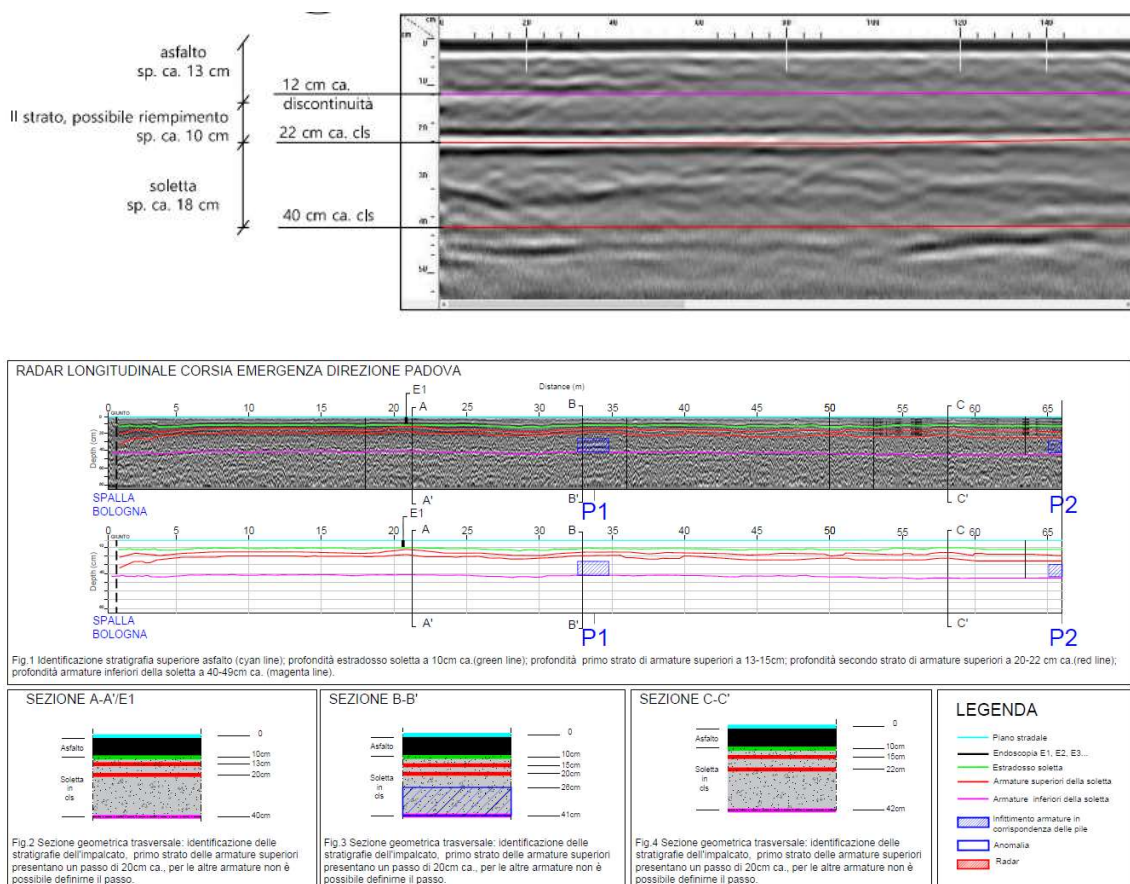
Esempio di restituzione – tecnica georadar per la rilevazione dello spessore della pavimentazione
